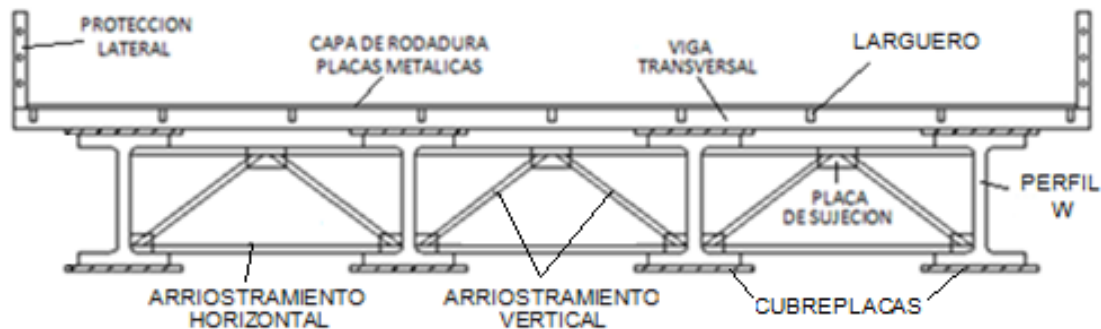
Sección transversal con vigas metálicas tipo perfil [21]
